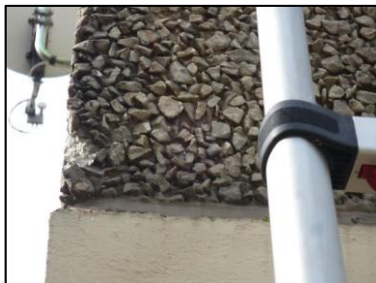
ECH-N°26 -BAT 177-277 pignons Murs béton+pierres
